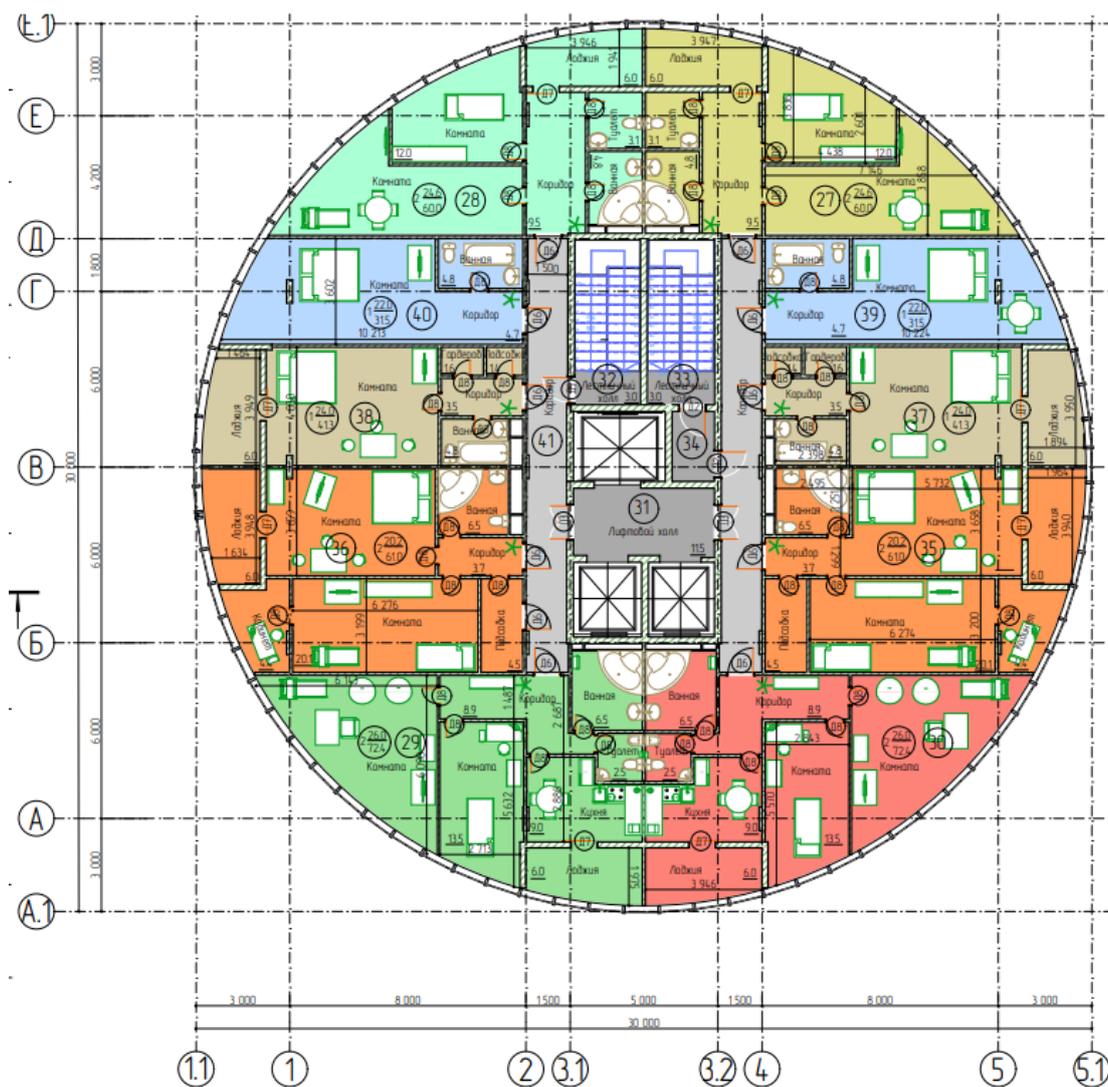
План типовых этажей с 2 по 12 этаж
